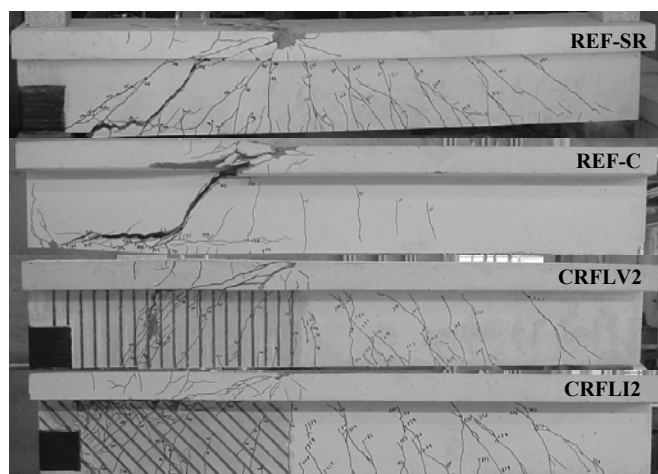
Vigas REF-SR, REF-C, CRFLV2 e CRFLI2 posteriormente aos ensaios
